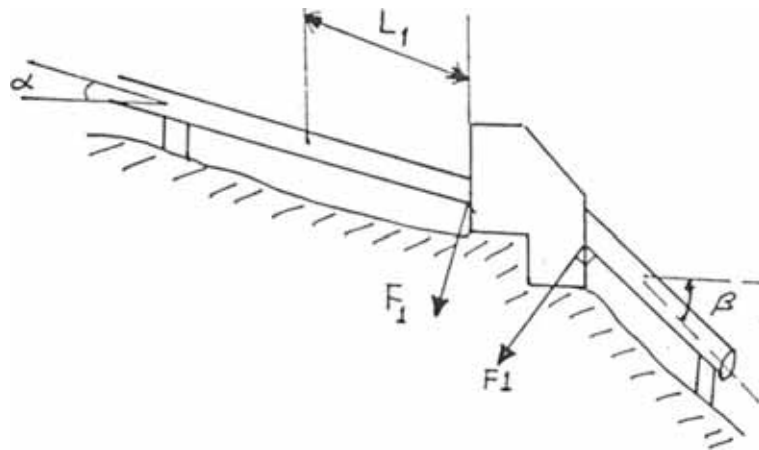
Componente del peso de la tubería perpendicular a ella (F_1)
